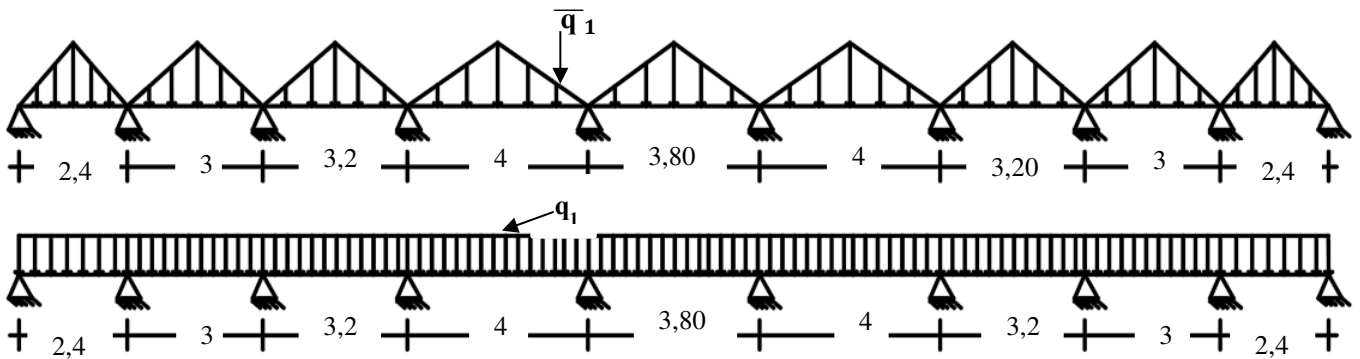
Distribution des charges sur les poutres secondaires.
